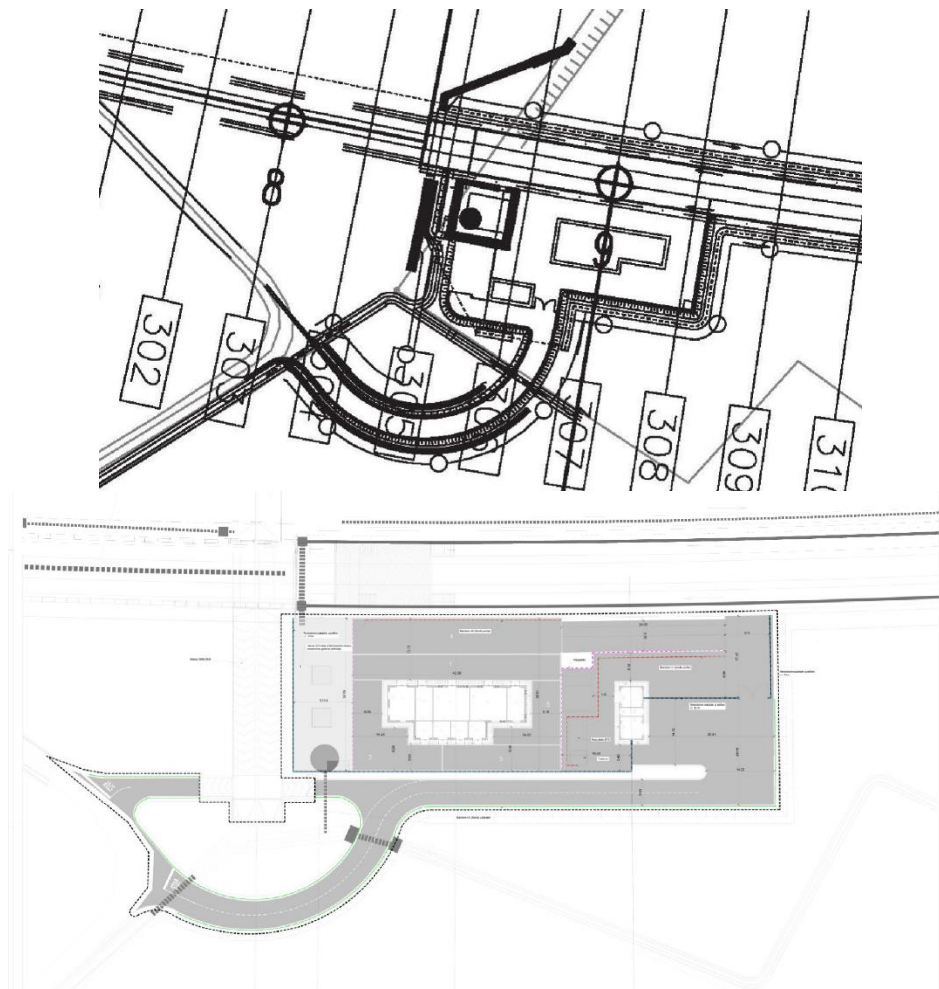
Confronto Planimetria di progetto definitivo e Planimetria di progetto esecutivo
